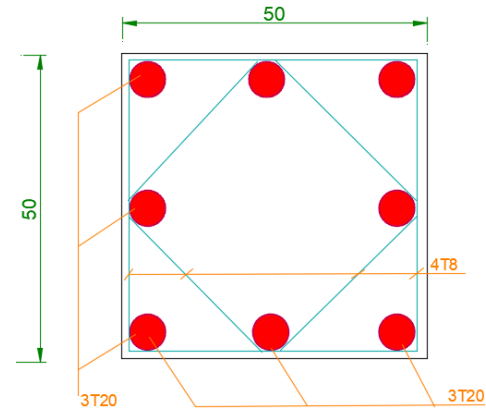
Schéma De Ferrailage Des Poteaux de 8^{eme} étage.
